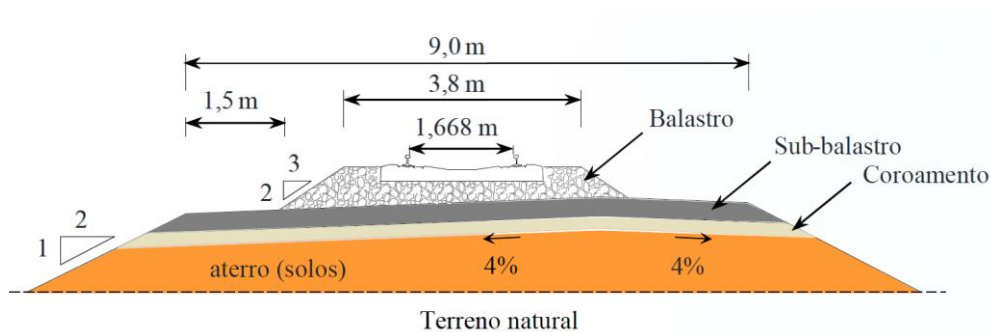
Representação esquemática da seção transversal padrão da via no aterro (adaptado de Paixão, 2014).
